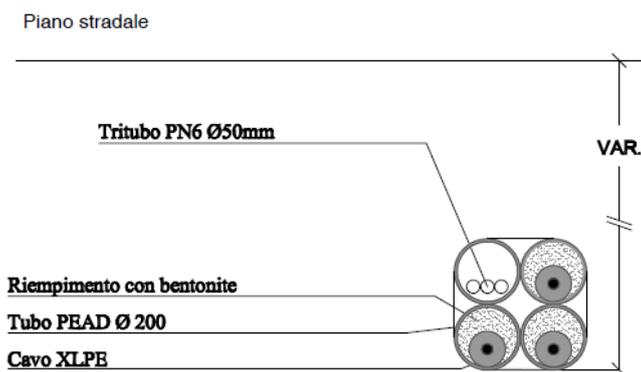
modalità di posa cavo 150 kV AT posato con trivellazione orizzontale teleguidata – sezione tipo Z
